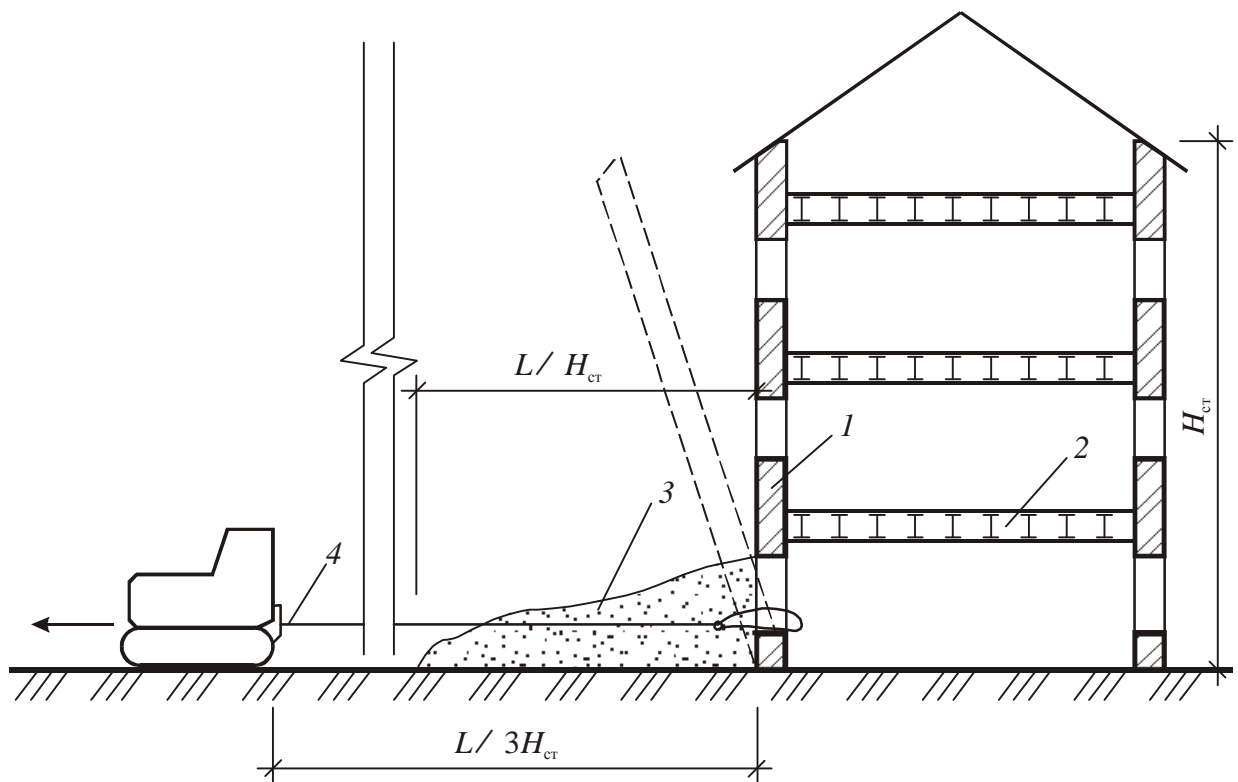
Валка зданий с самонесущими наружными стенами:
